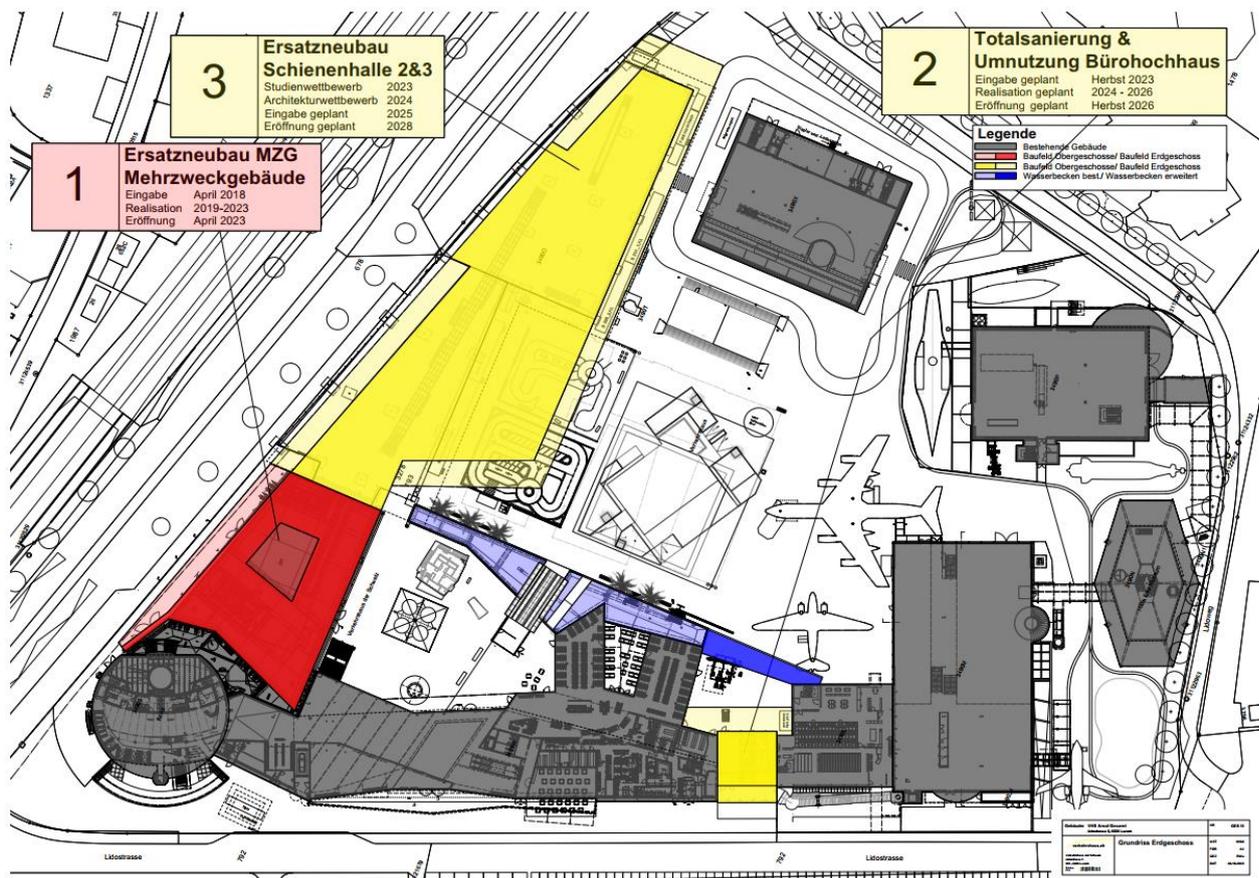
Etappierung Masterplanprojekte, VHS, Stand 2022 (Plandarstellung ist nicht genordet)
